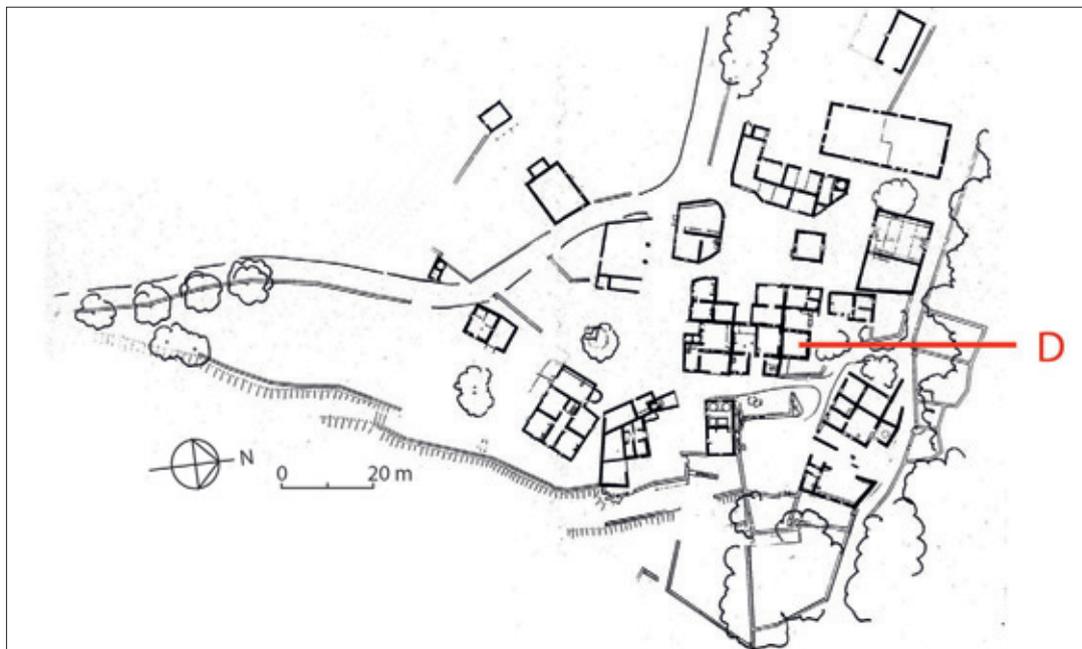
PLAN DU HAMEAU DE NAUDIN EN 2000. Dessin Ch. Darles.
